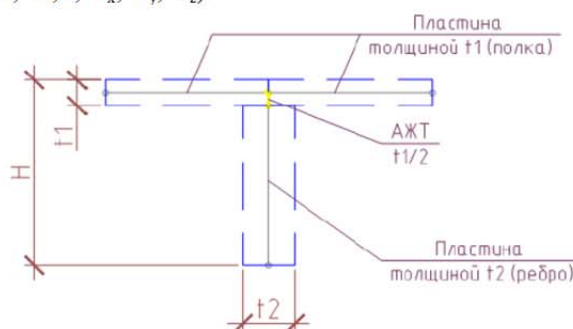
Третий способ моделирования кессонных перекрытий
